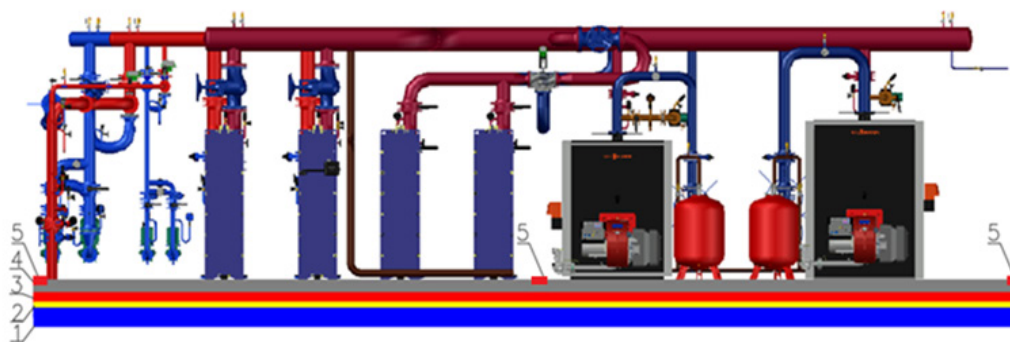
Схема установки инженерного оборудования крышной котельной на плите покрытия здания (с двумя контурами упругого звукоизоляционного слоя):
